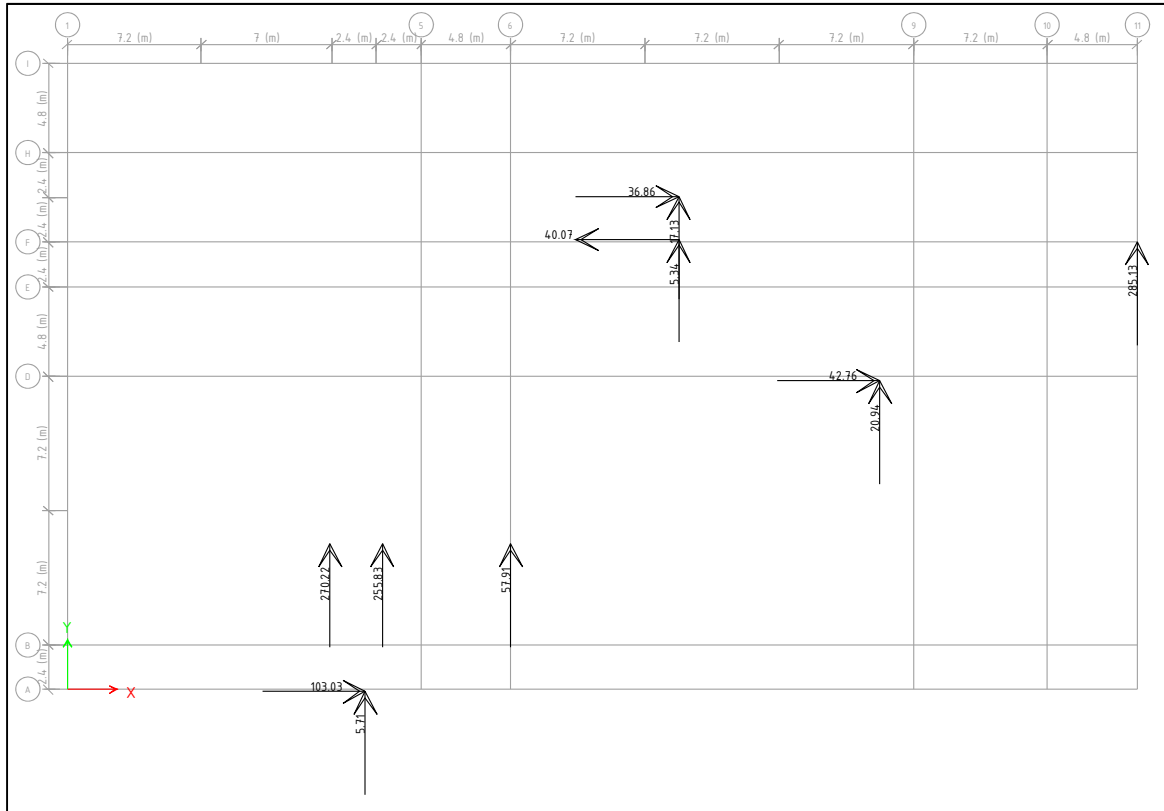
HORIZONTALA LASTER: DEKKE OVER 1.-3.ETG
